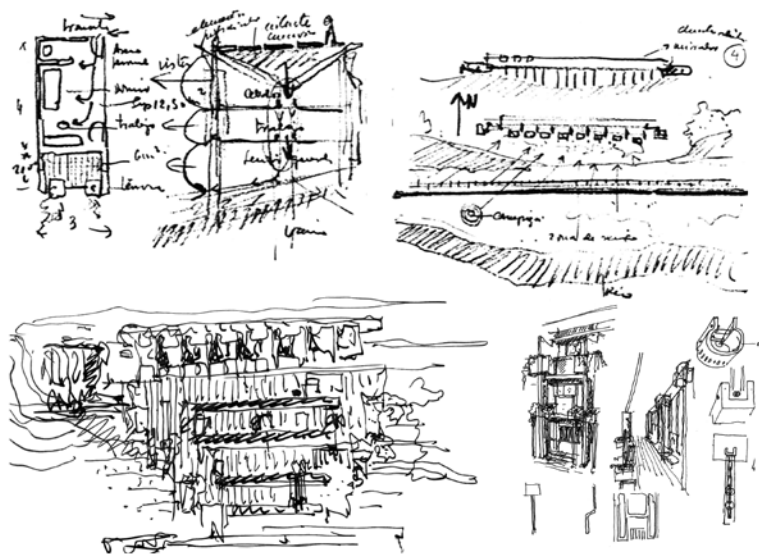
Croquis de plantas de celdas, su disposición en el conjunto y detalles de fachada sur. Fechados en 1968. Fuente: FERNÁNDEZ ALBA, A.; CASTRO, C. El nuevo Carmelo de Salamanca. *Revista Arquitectura*, Madrid, 1971, n. 152, pp. 52-58.
